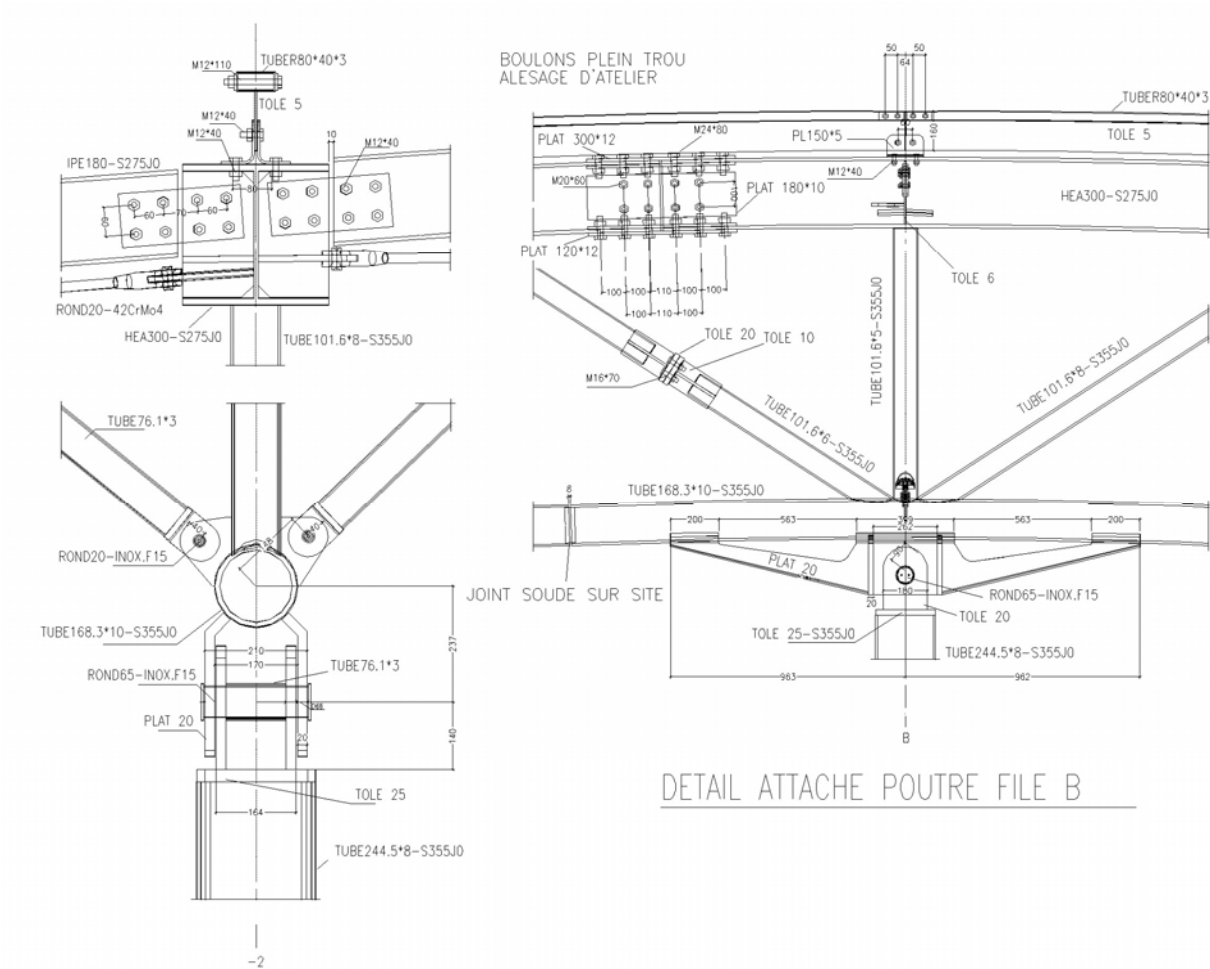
Détail des attaches de ferme au droit d'un poteau intérieur
